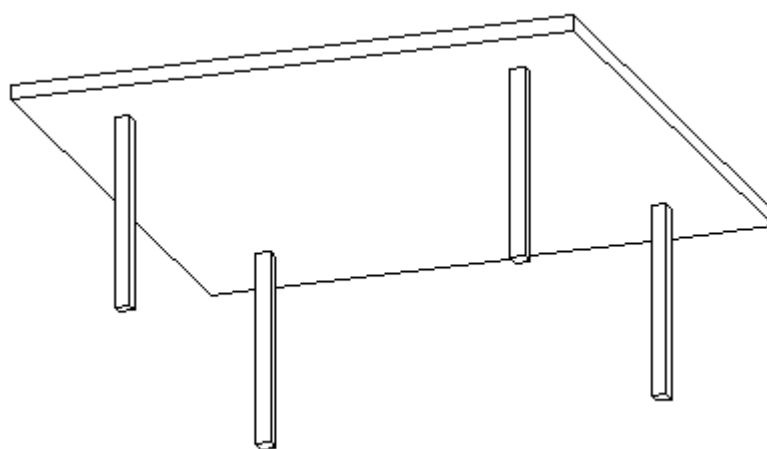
Perspectiva de um pavimento com laje-cogumelo
